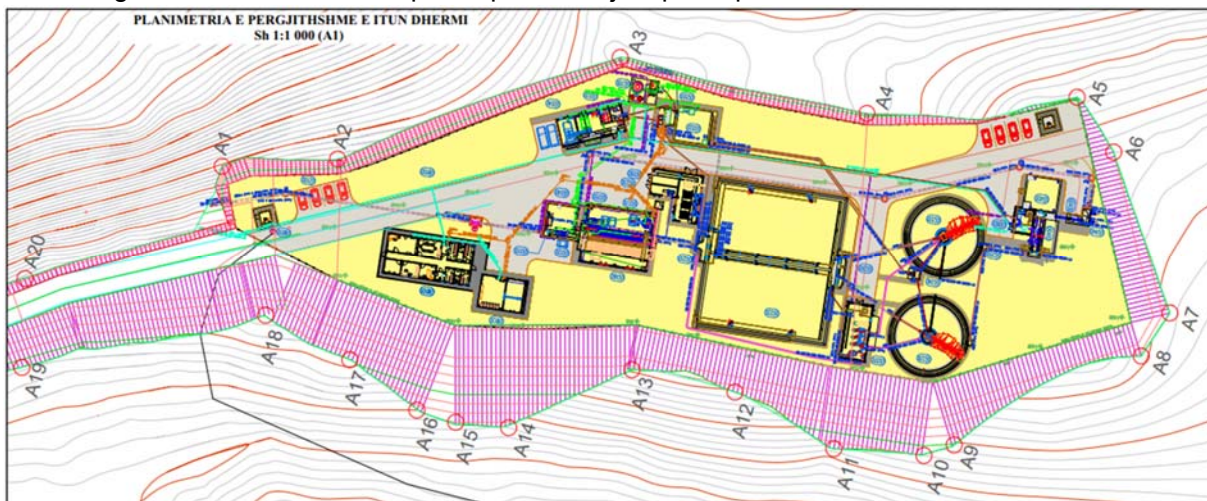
Planimetria e pergjithshme e ITUN Dhermi
